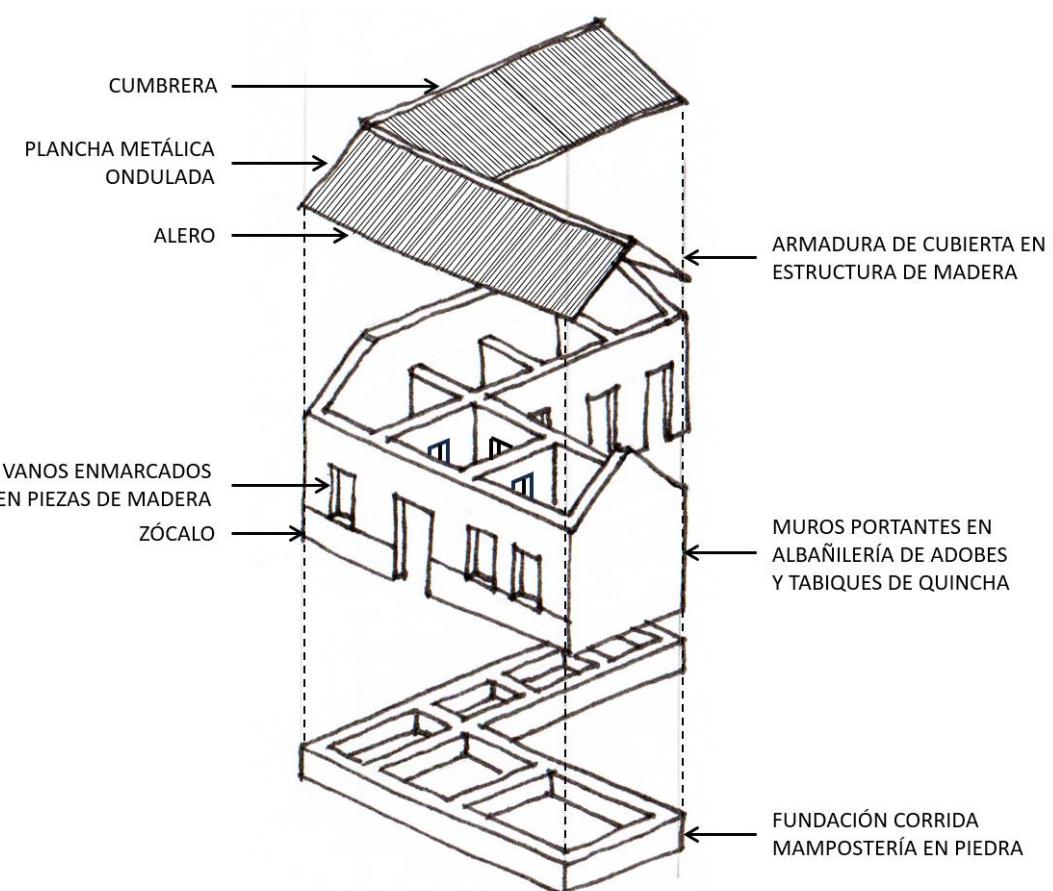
Ejemplo inmueble tipo del Poblado de Barraza.
